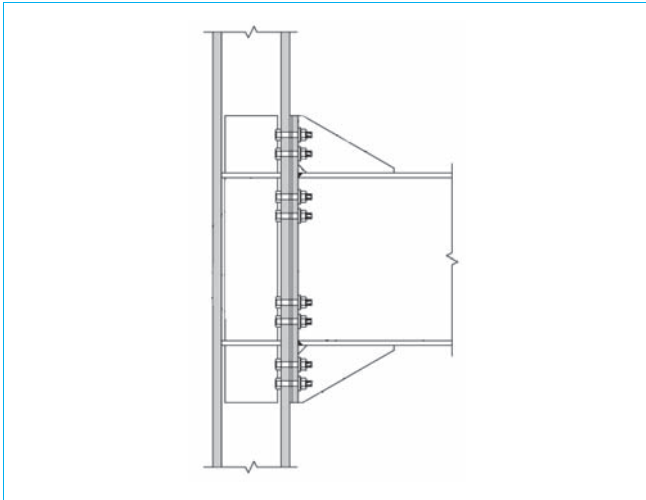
Assemblage par platines d'about raidies soudées à la poutre et boulonnées à l'âme du poteau par 8 rangées de boulons (d'après la norme FEMA 350)
